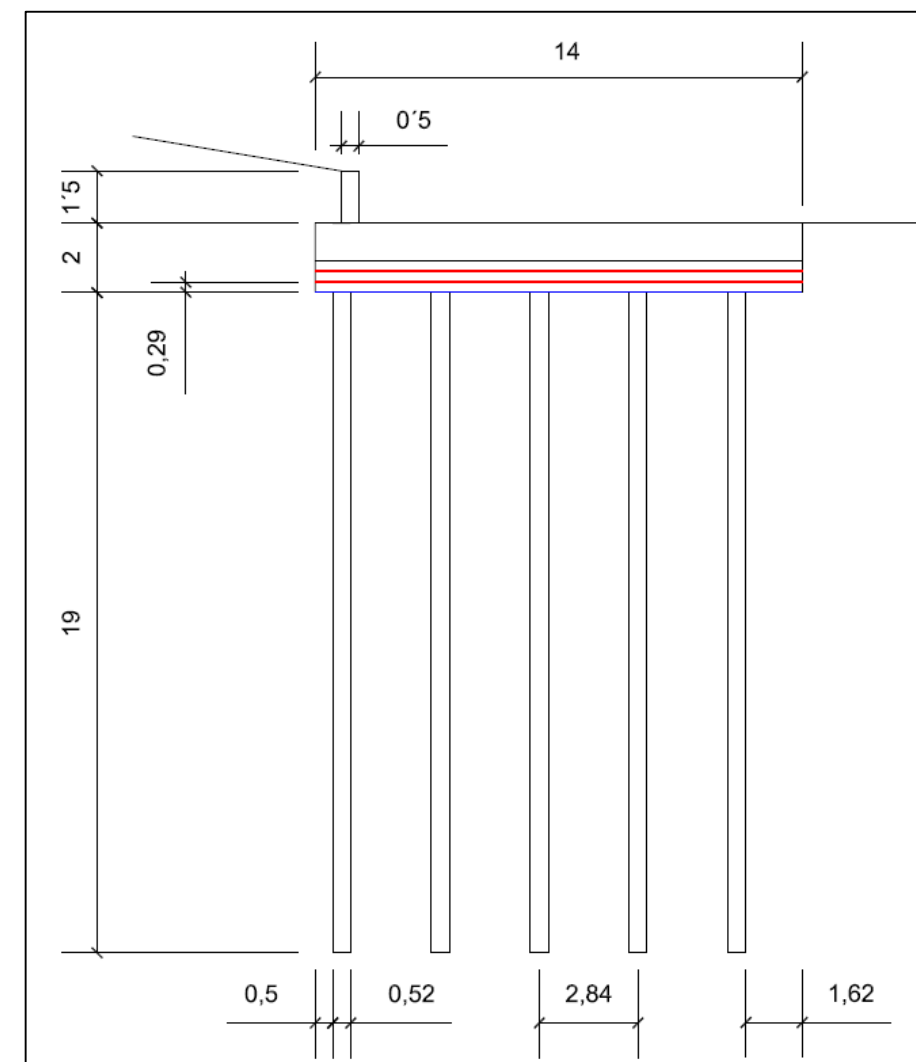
Recorte del plano acotado de la solución proyectada. Fuente: Elaboración propia
